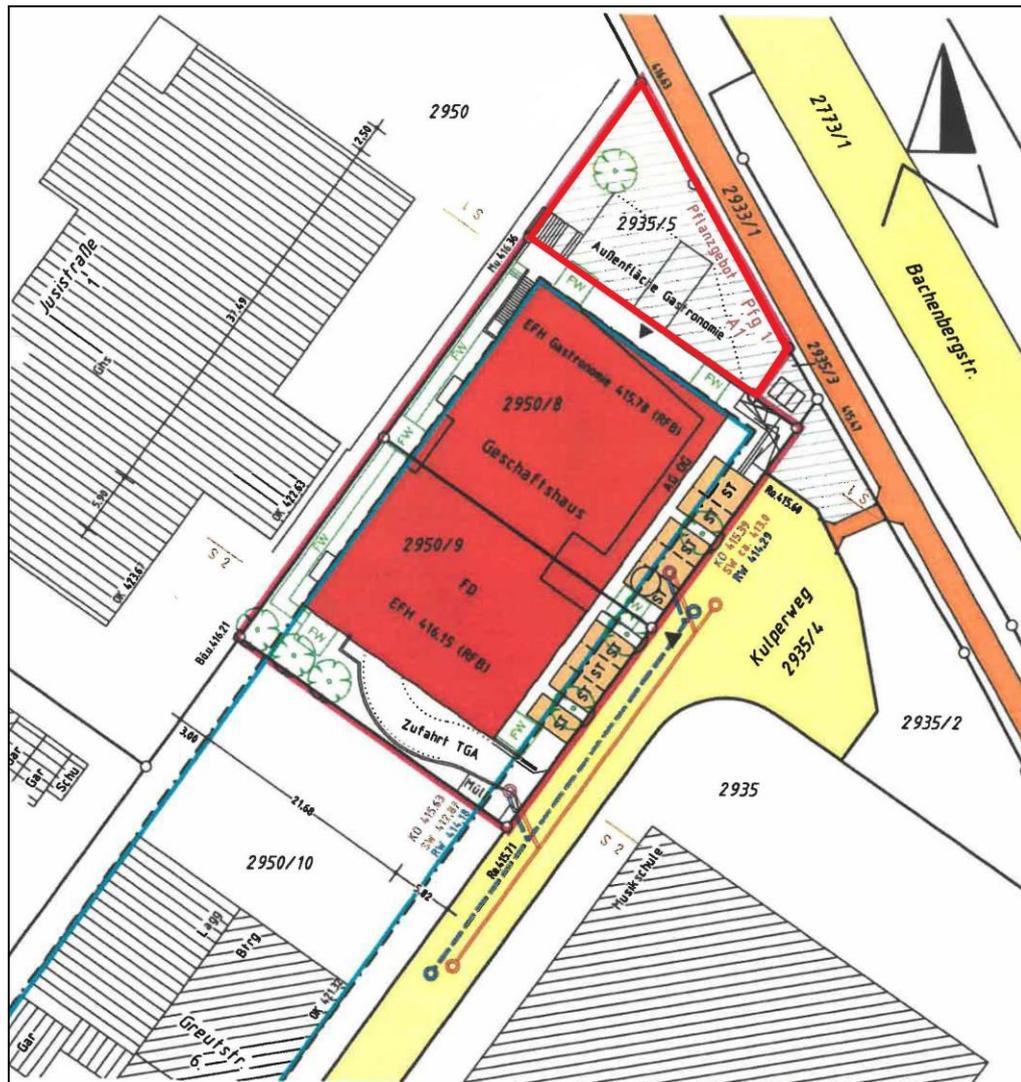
Ausschnitt aus dem Planteil zum Bebauungsplan
